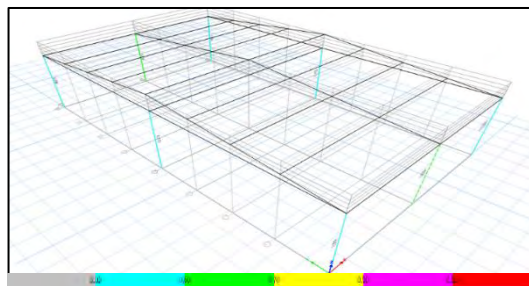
Aulas de informática. Los elementos de color verde son las columnas C4 y C7
